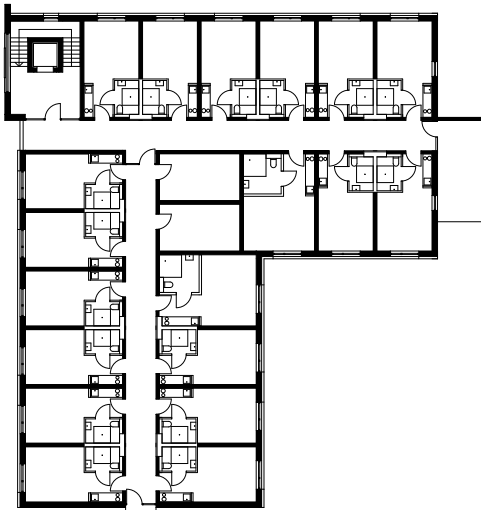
Grundriss Regelgeschoss, M. 1:500
